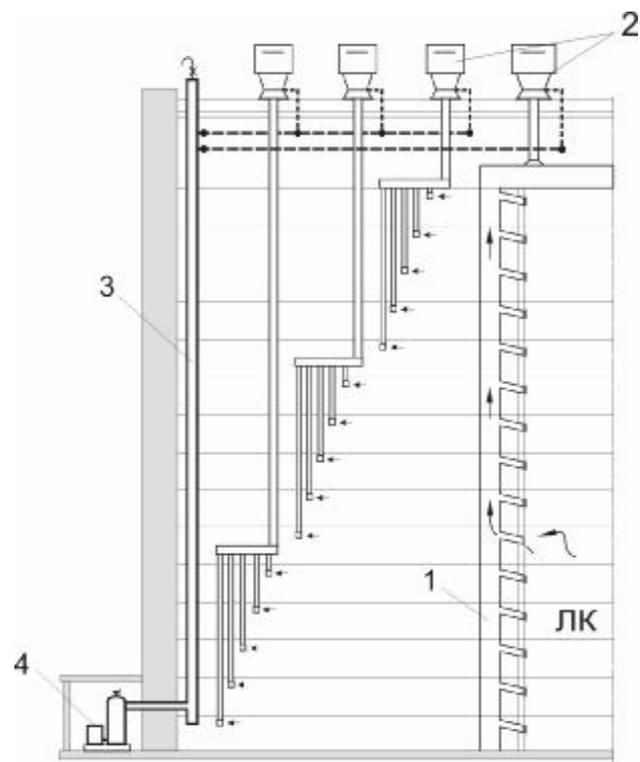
Схема одного из возможных вариантов аварийной вентиляции жилого дома при пожаре и безветрии в теплый период года: ЛК – лестничная клетка; 1 – шахта противодымной вентиляции; 2 – дефлекторы периодического действия на сжатом воздухе; 3 – труба-ресивер; 4 – компрессор с ресивером
